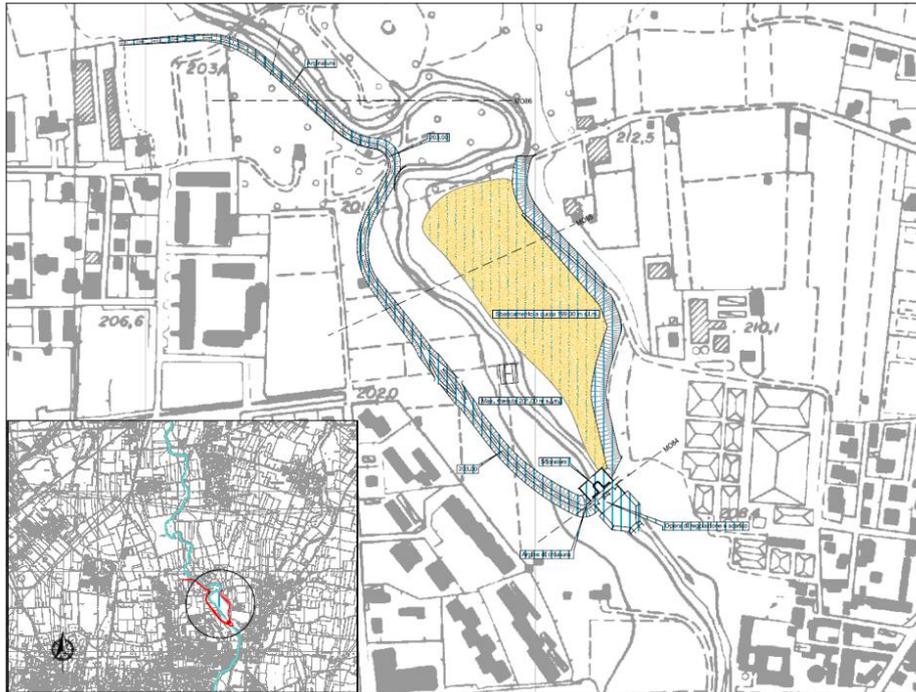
Ubicazione e planimetria dell'area di laminazione di Lomagna
